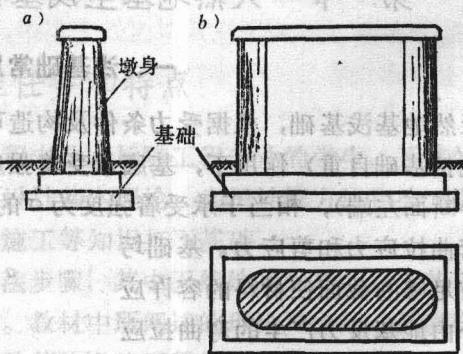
刚性扩大基础 (a) 垂直剖面图 (b) 平面图
